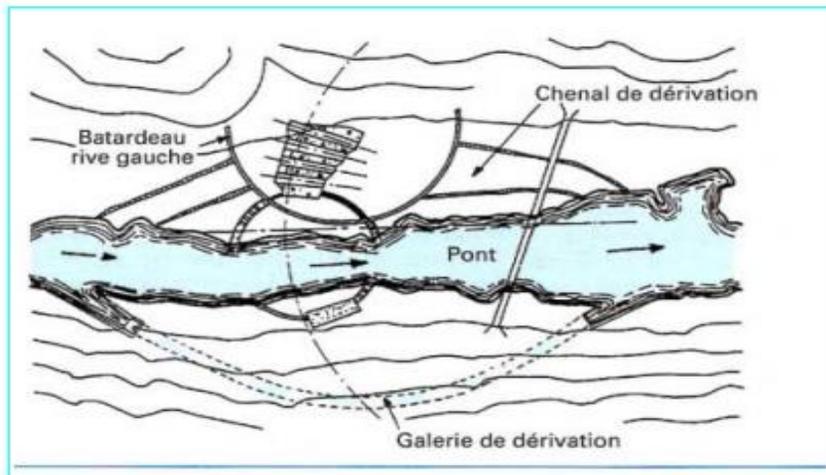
Batardeaux du chantier du barrage de Kariba (Zambie-Zimbabwe) (d'après Technique des travaux, janvier 1962)
